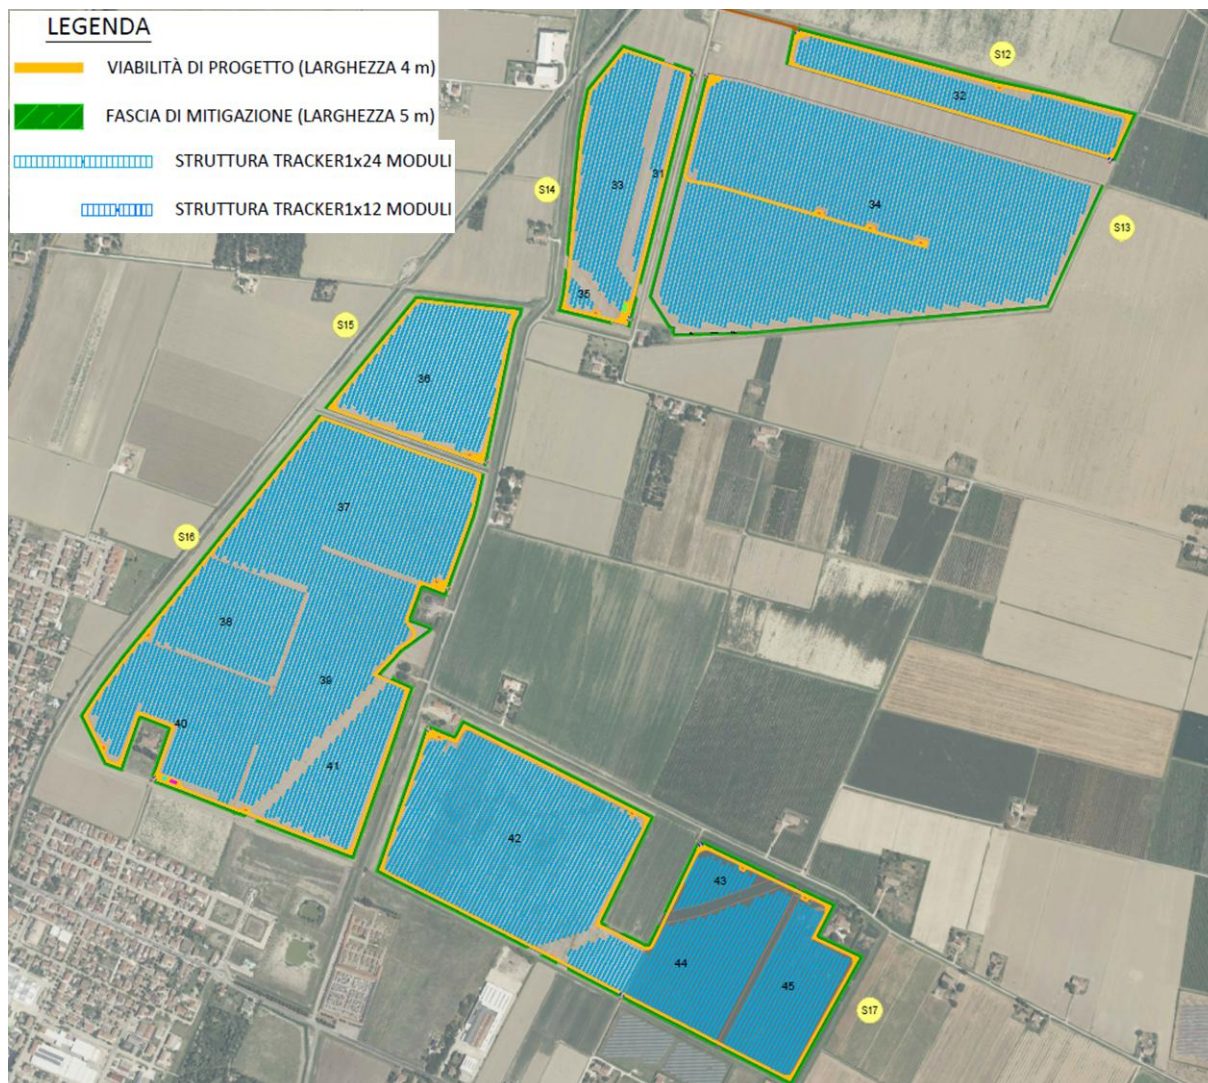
Layout di impianto – Lotto Sud. Fonte: 3342_6955_CNS_T07.2_Rev0_Layout di progetto, Montana, 2026
